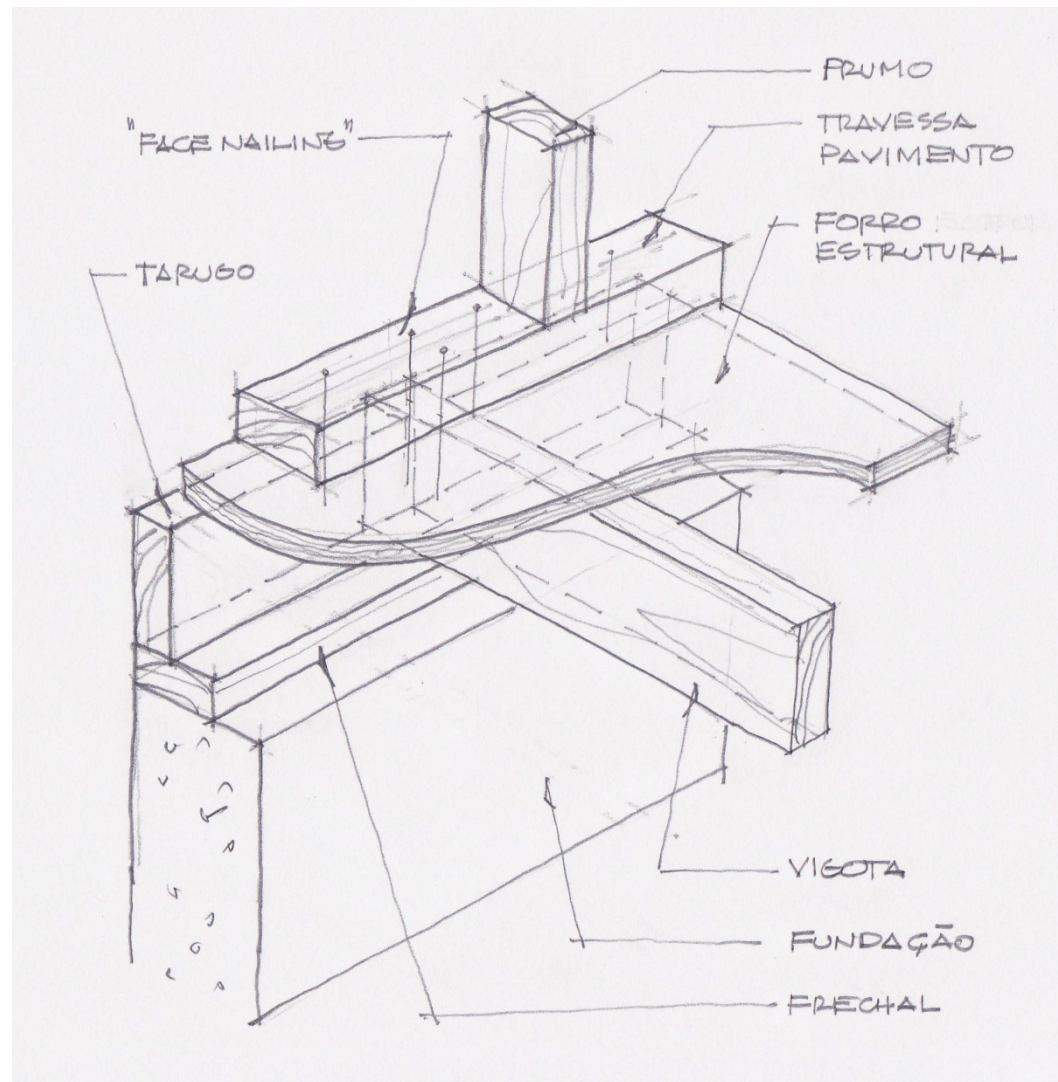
Pregagem da travessa de pavimento a vigotas e tarugos. (des. autor)
